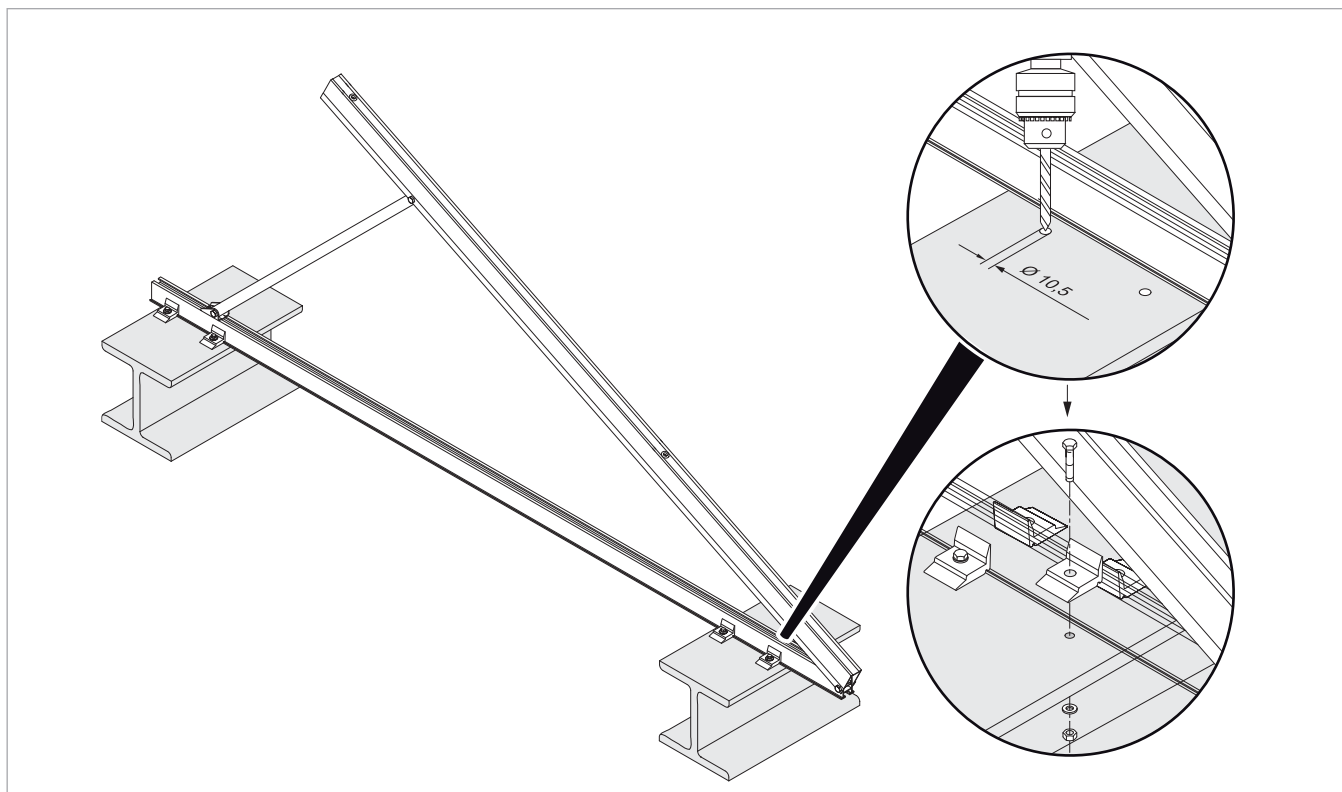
montaggio del supporto per tetto piano su supporto in acciaio
